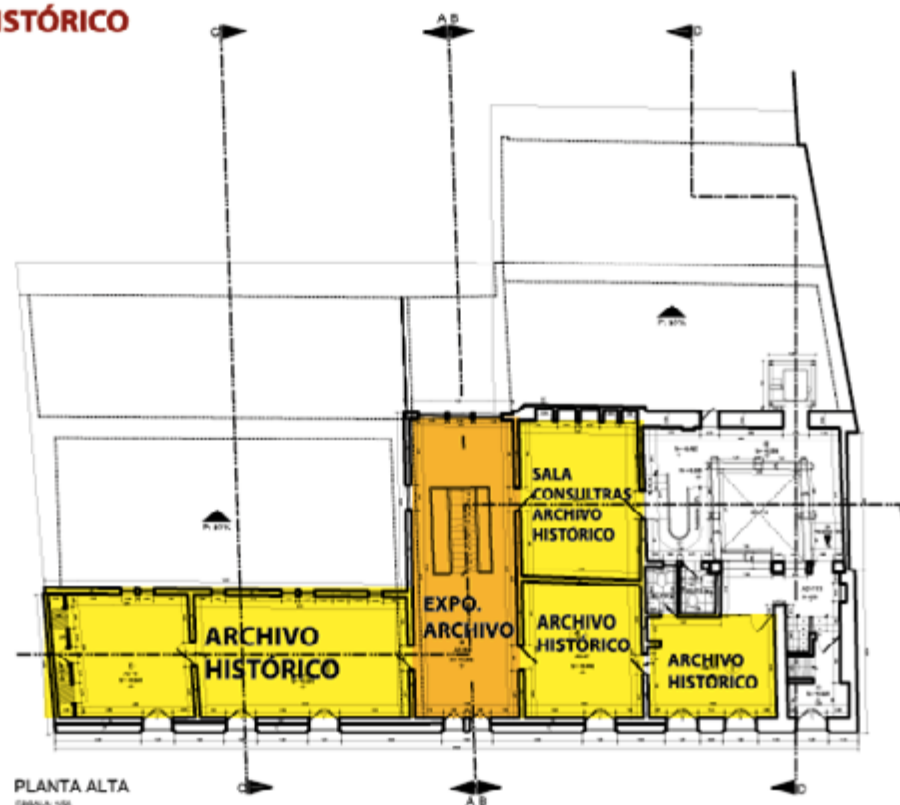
Imagen de la primera planta alta de la Casa museo Remigio Crespo.
